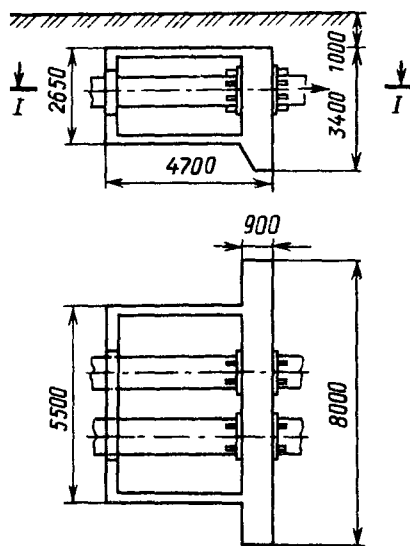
Железобетонная неподвижная опора в виде камеры из монолитного железобетона для больших усилий (более 2000 кН)
